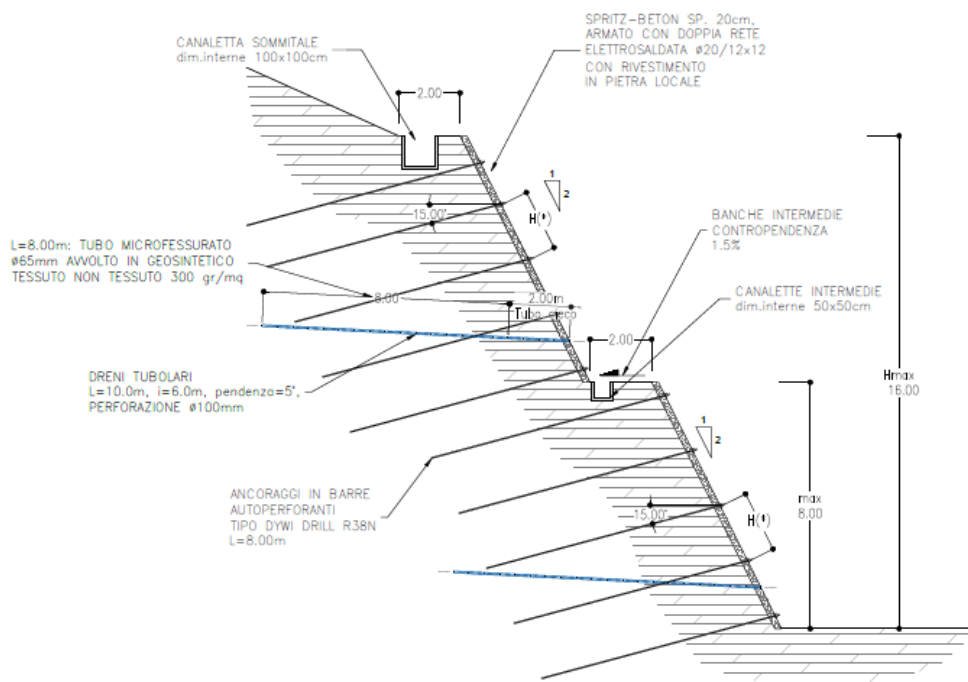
Sezione tipo scavo in marne tenere TS-D
